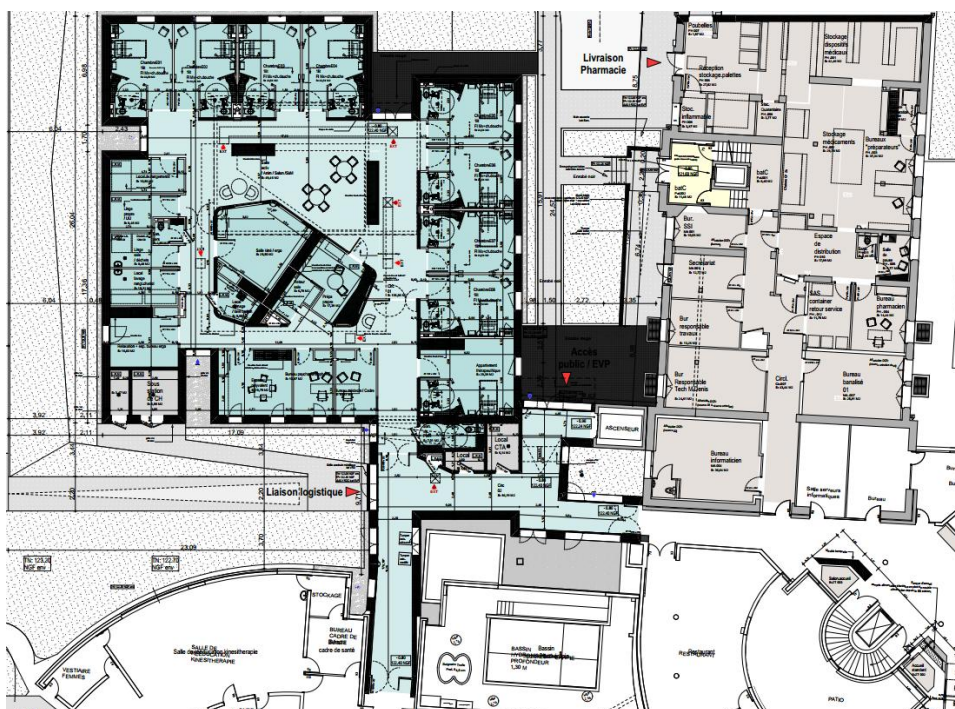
Plan du RDC de l'EVP et du Bâtiment C
